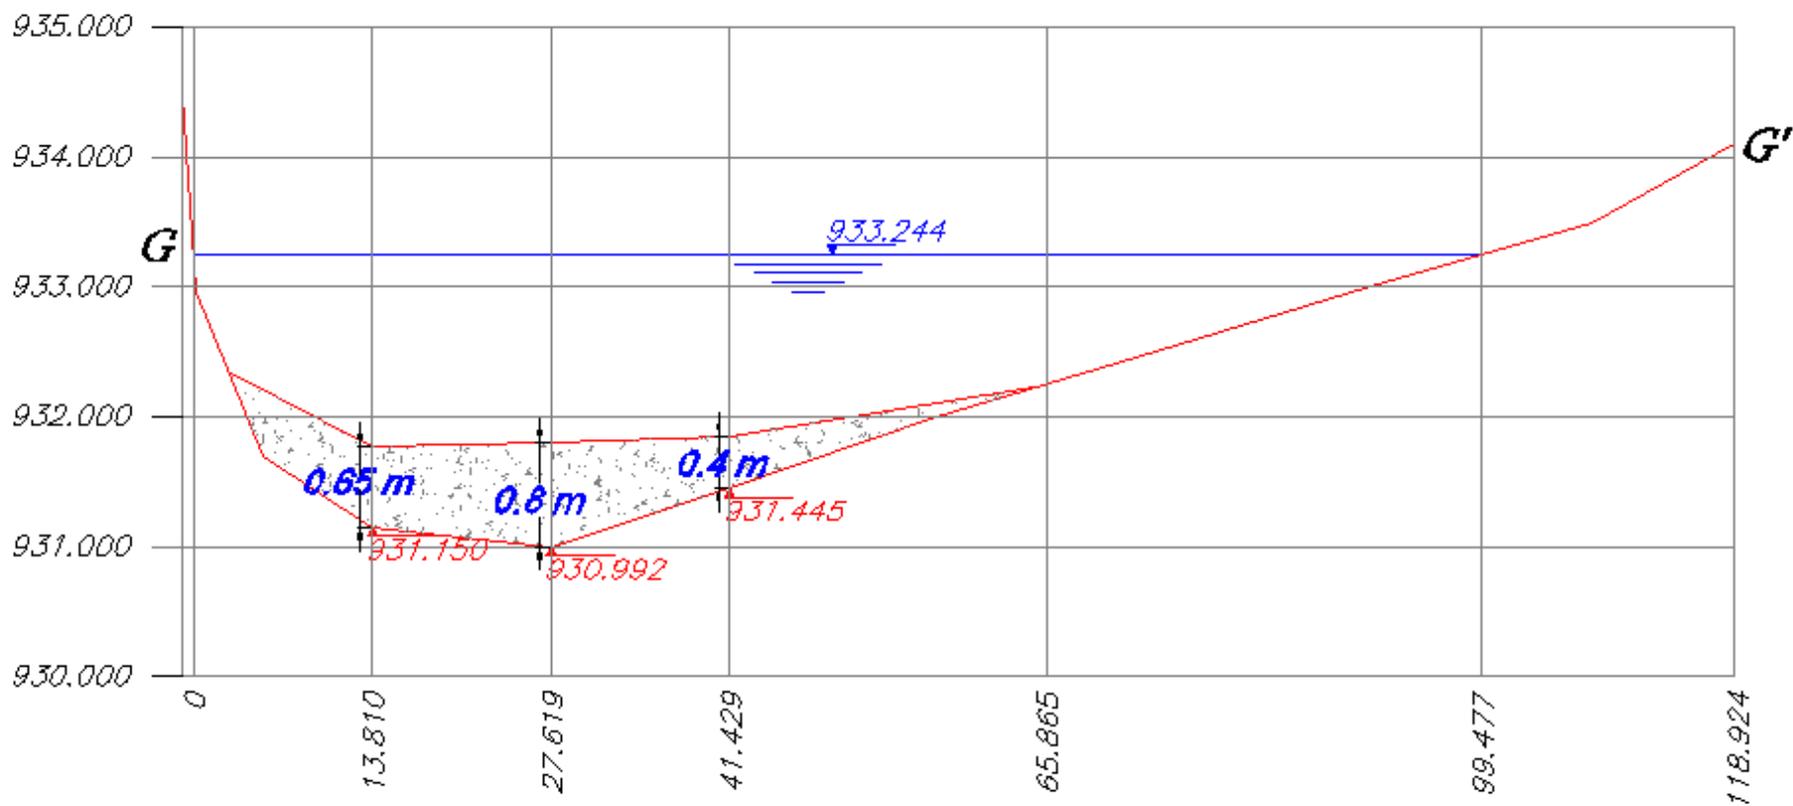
Perfil G – G' Madre Vieja Carabalo.
